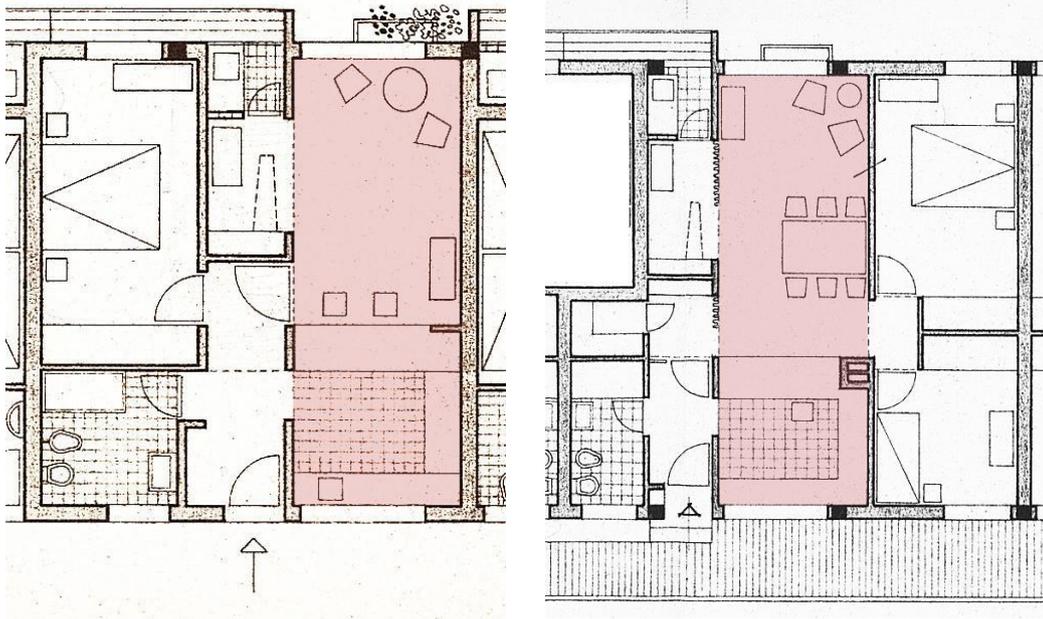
e 213 - Planta da habitação do tipo 1 e tipo 2 com a identificação da zona social
